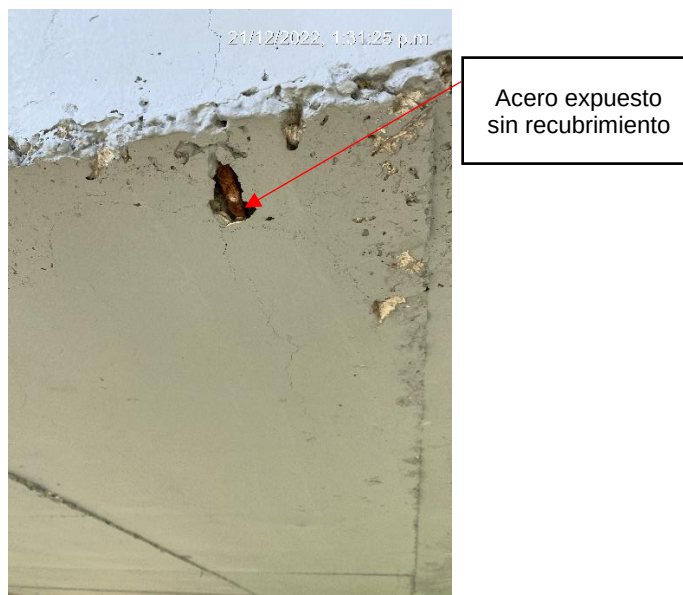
Vista De Viga Cajón Apoyo Columna
